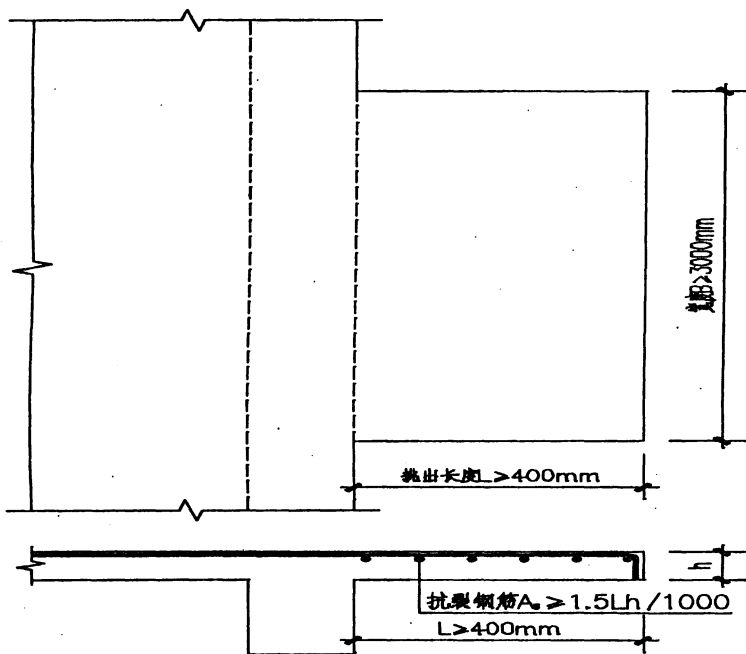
室外悬挑板抗裂配筋
